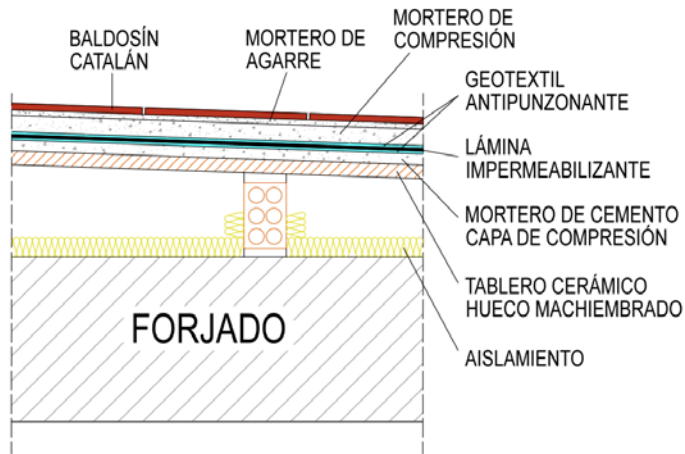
Sección terraza actual. Cubierta plana transitable. Fuente propia.
